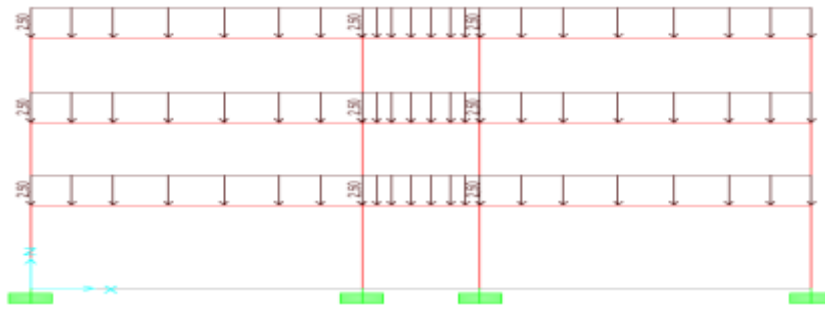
Distribusi pembebanan balok lantai dan balok atap pada struktur portal
